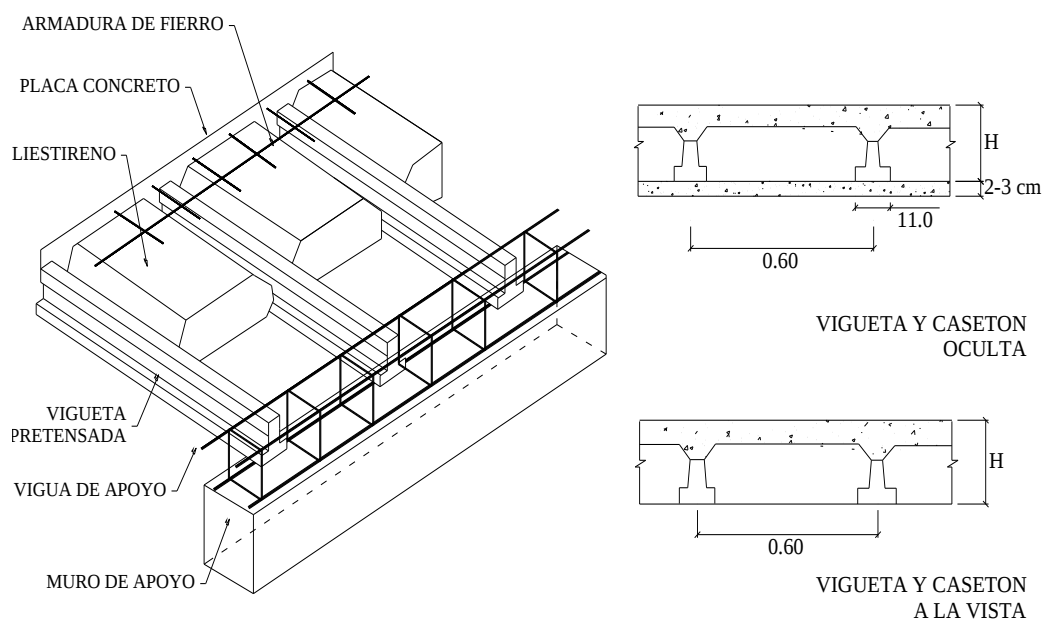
Colocación de casetones sobre viguetas prefabricadas.
